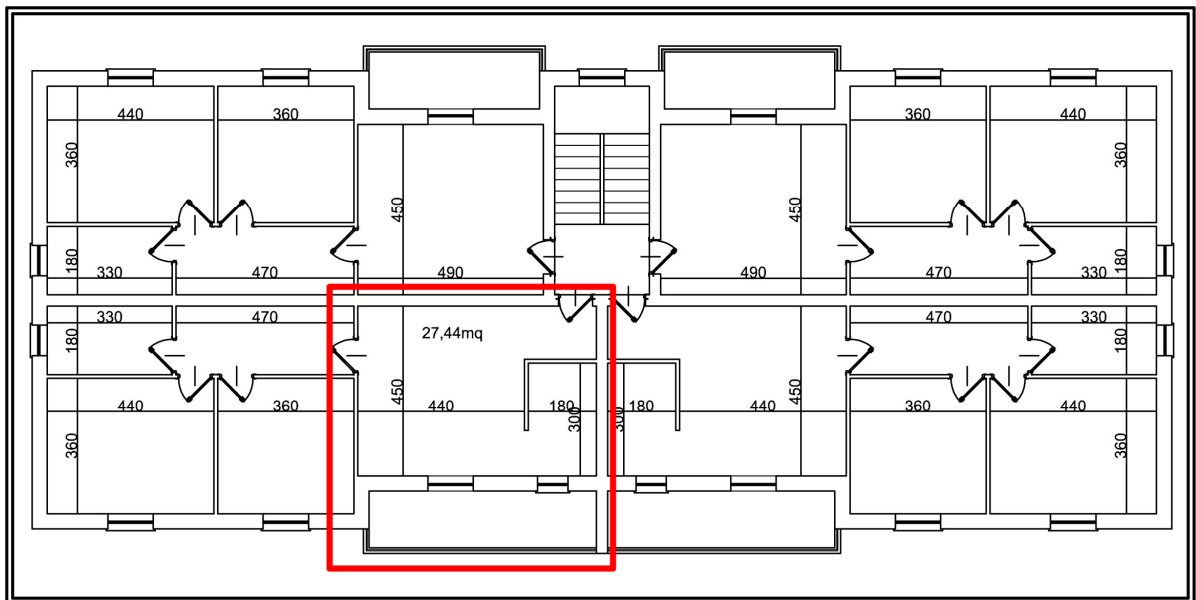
Individuazione in pianta della facciata e della stanza collegata, oggetti dello studio.
